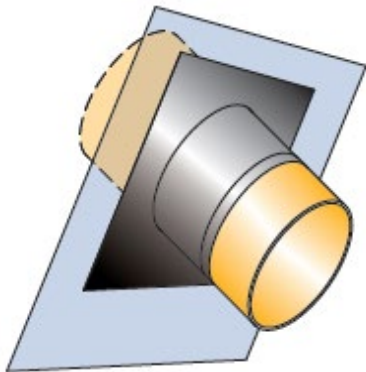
Etanchéité à l'air par remplissage + manchon + finition d'enduit
